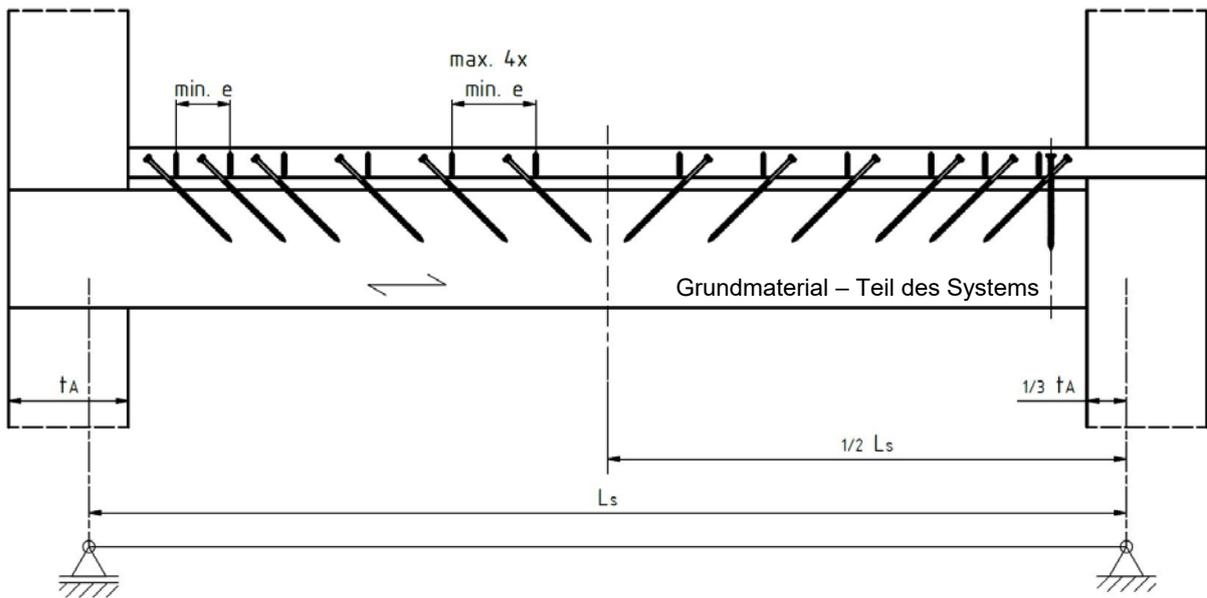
Grundsätzlicher Aufbau des Holz-Beton-Verbund-Systems
